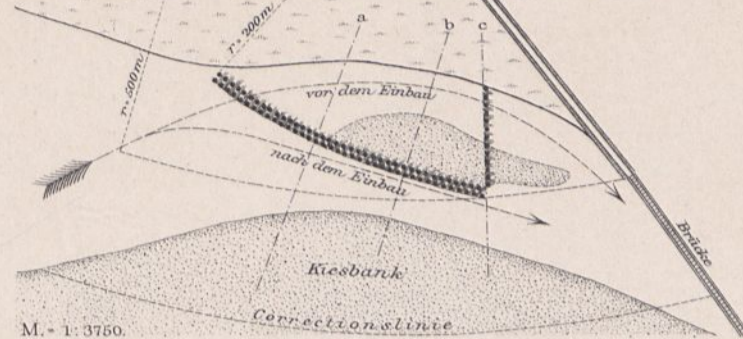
Lageplan bei der Oberpöringer Brücke.
